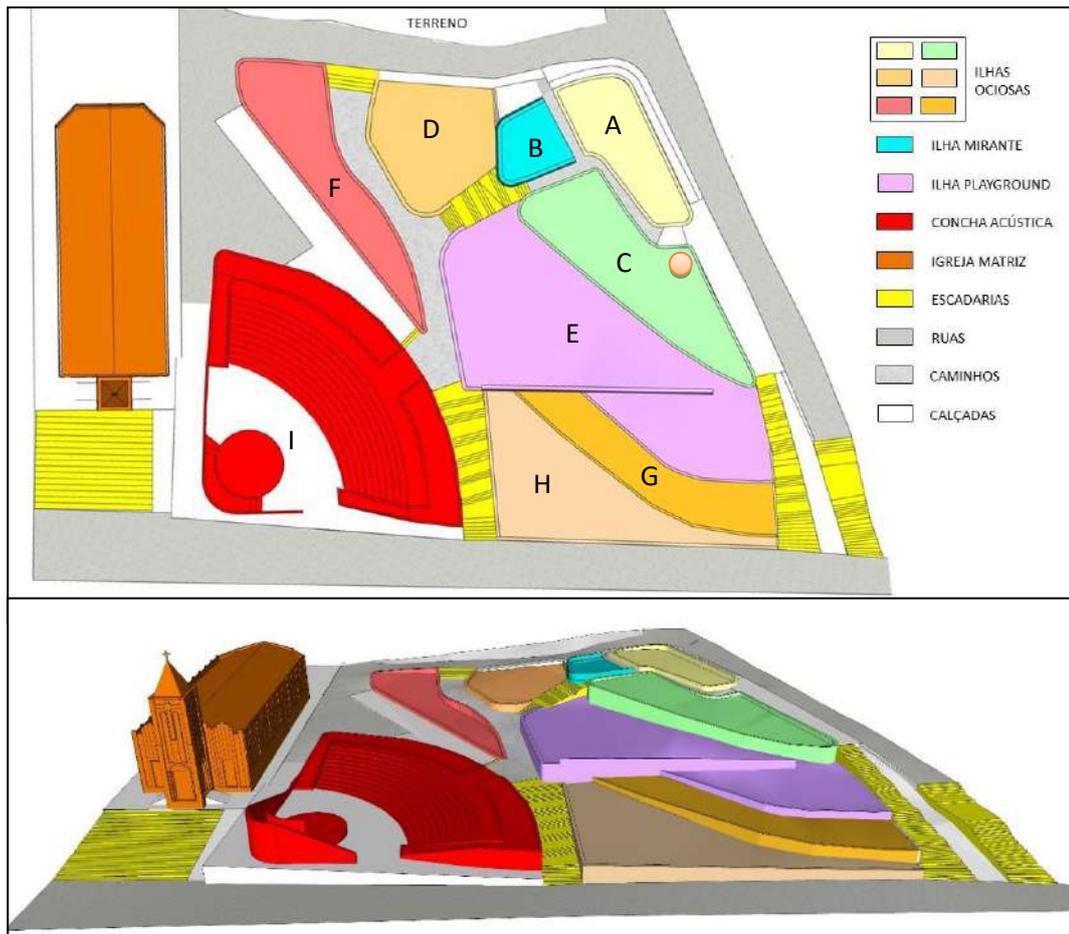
Zoneamento atual da Praça Padre Lima em planta e 3D.
